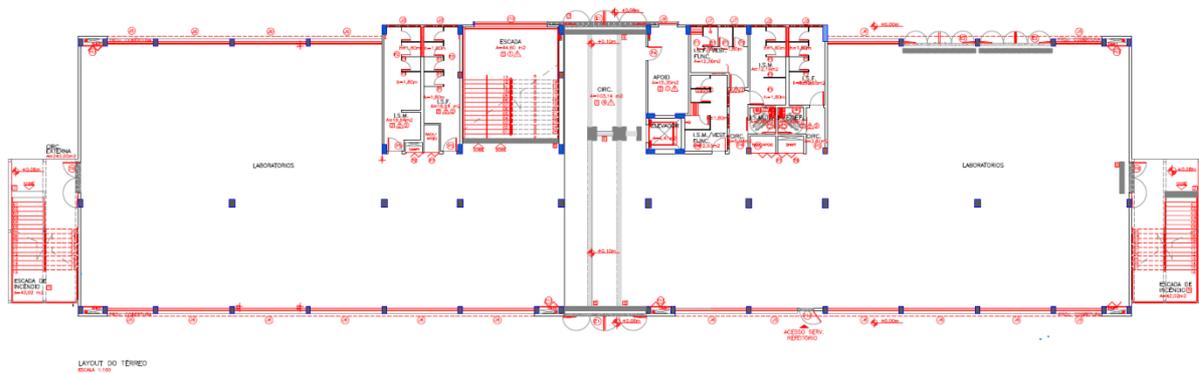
Planta baixa do 1º pavimento do Bloco C
